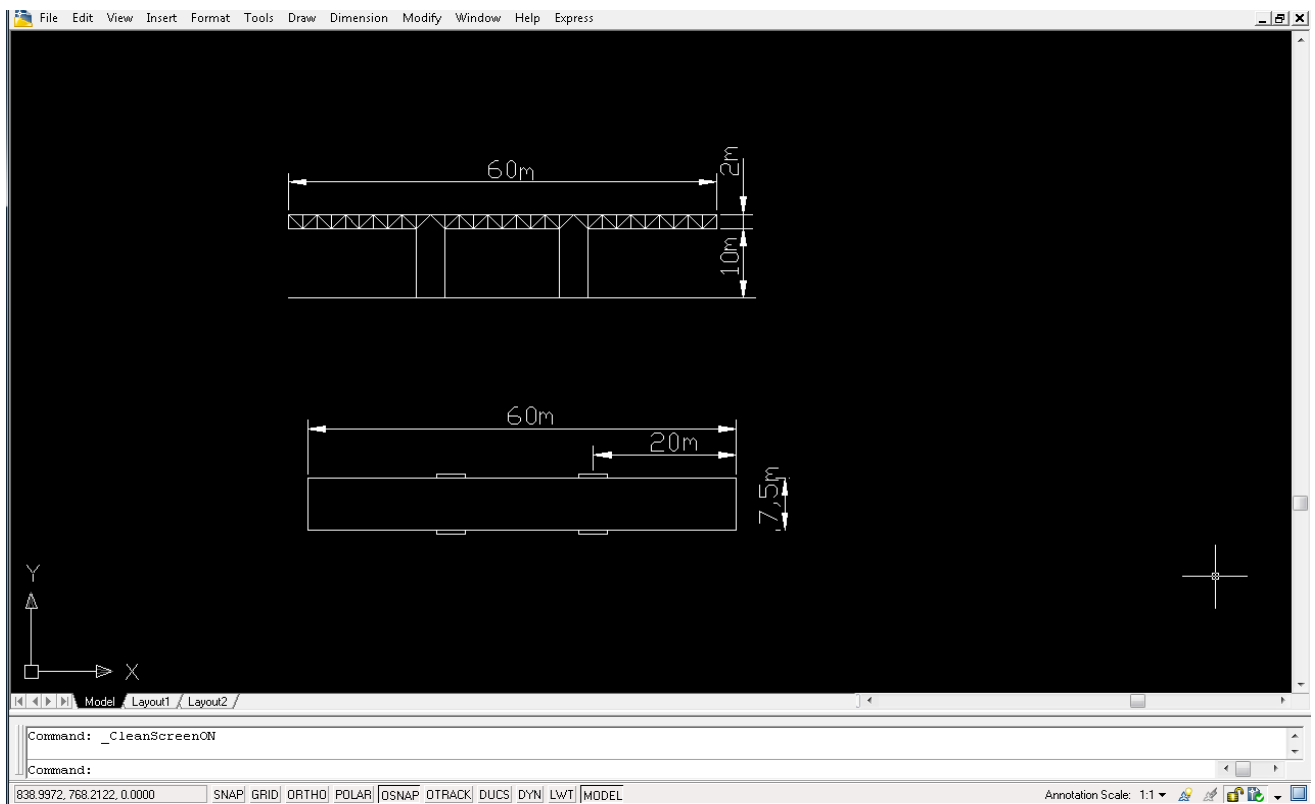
Dibujo del puente en alzado y planta.⁸
